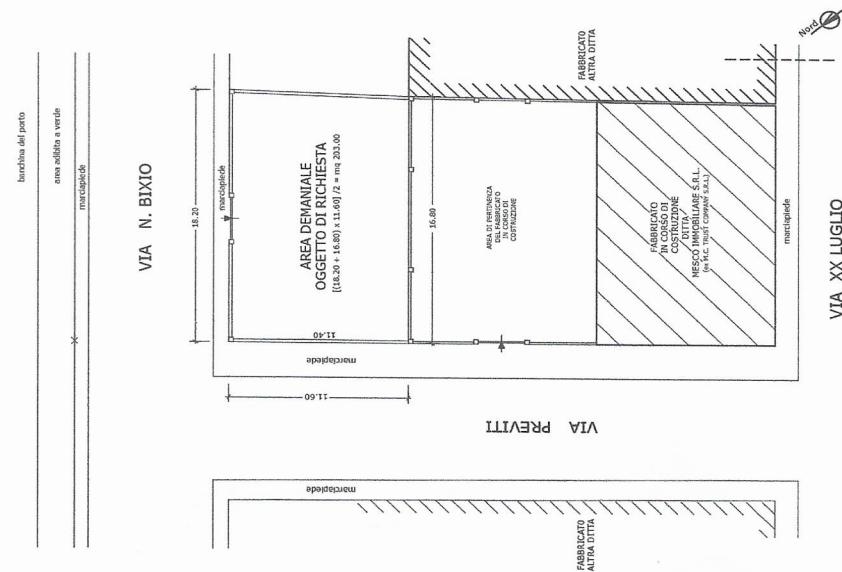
Planimetria con individuazione dell’area oggetto di sdemanializzazione
